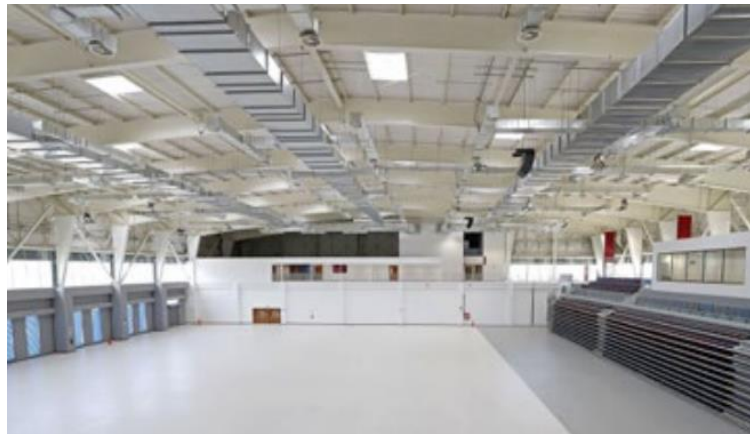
Sistema estructural de los edificios deportivos. Fuente: Construcción e Industria.
